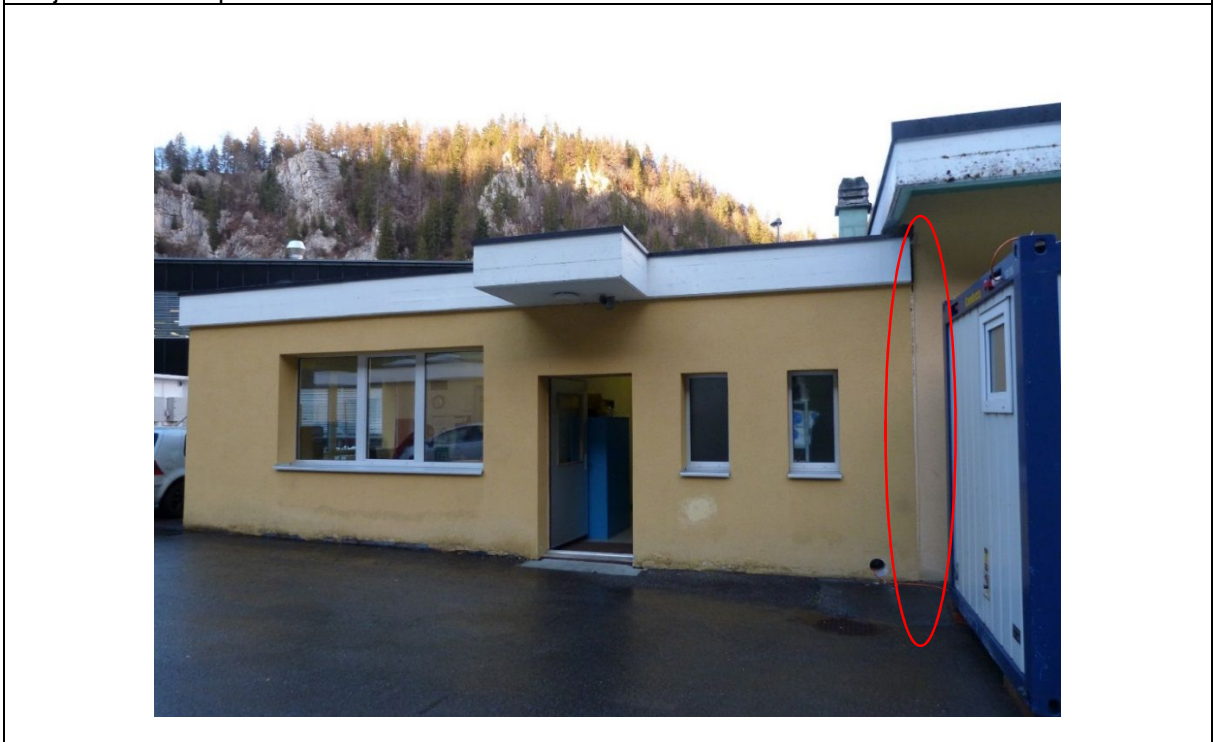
Façade Sud-Ouest du bâtiment entre la zone "filtration" et la zone "atelier" (à gauche)
